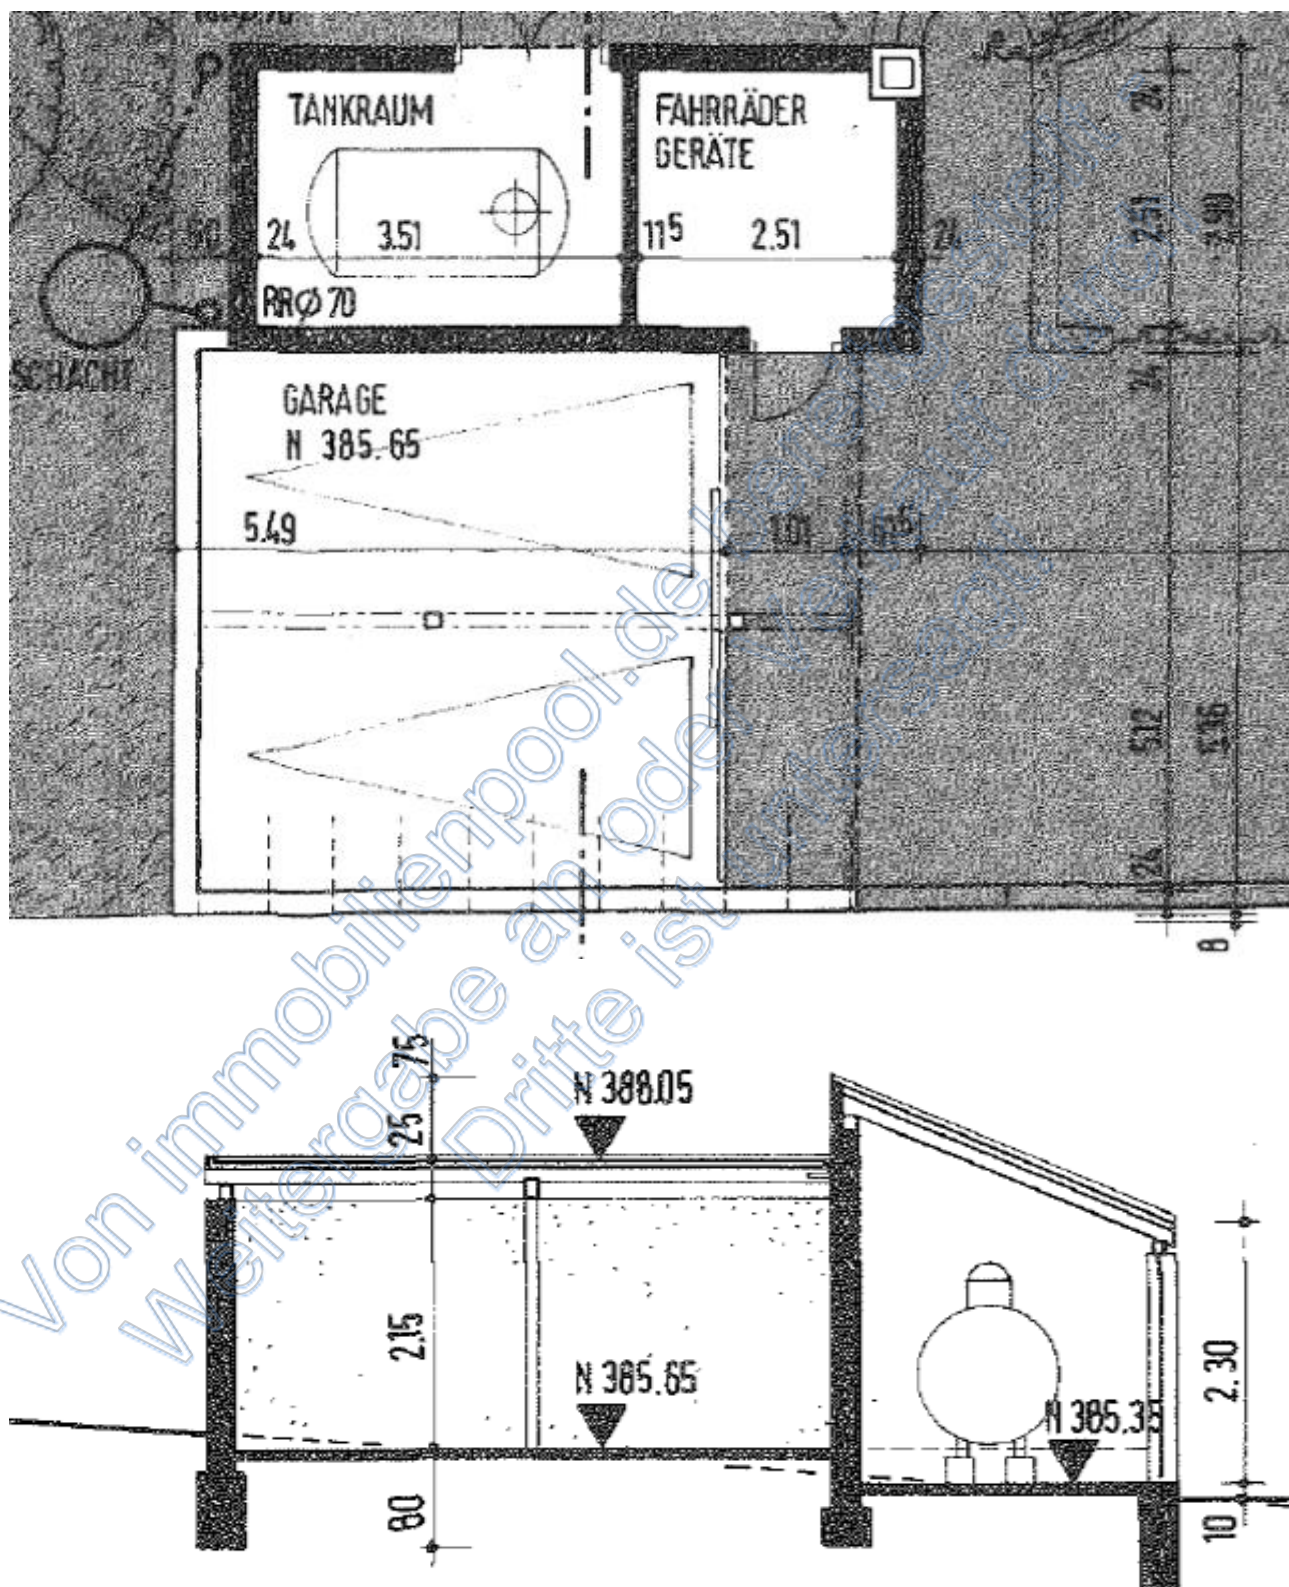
Grundriss und Schnitt (B) Garage mit Tank- und Geräteraum; Quelle: Bauakte (Planänderung zum Baugesuch vom 15.12.1976)
